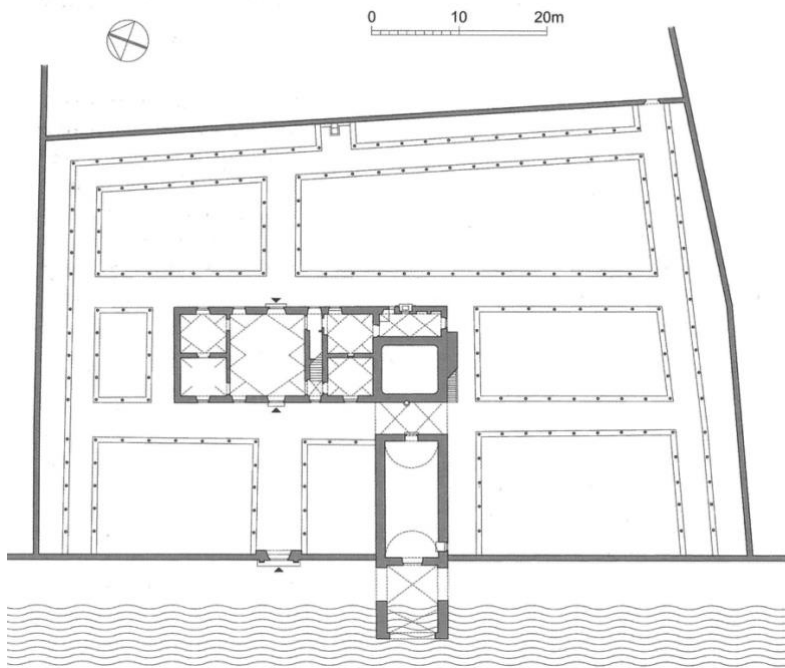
Sommerresidenz Bunić Gradić, Grundriss des Erdgeschosses mit Garten, aufgenommen im Jahr 1965.
